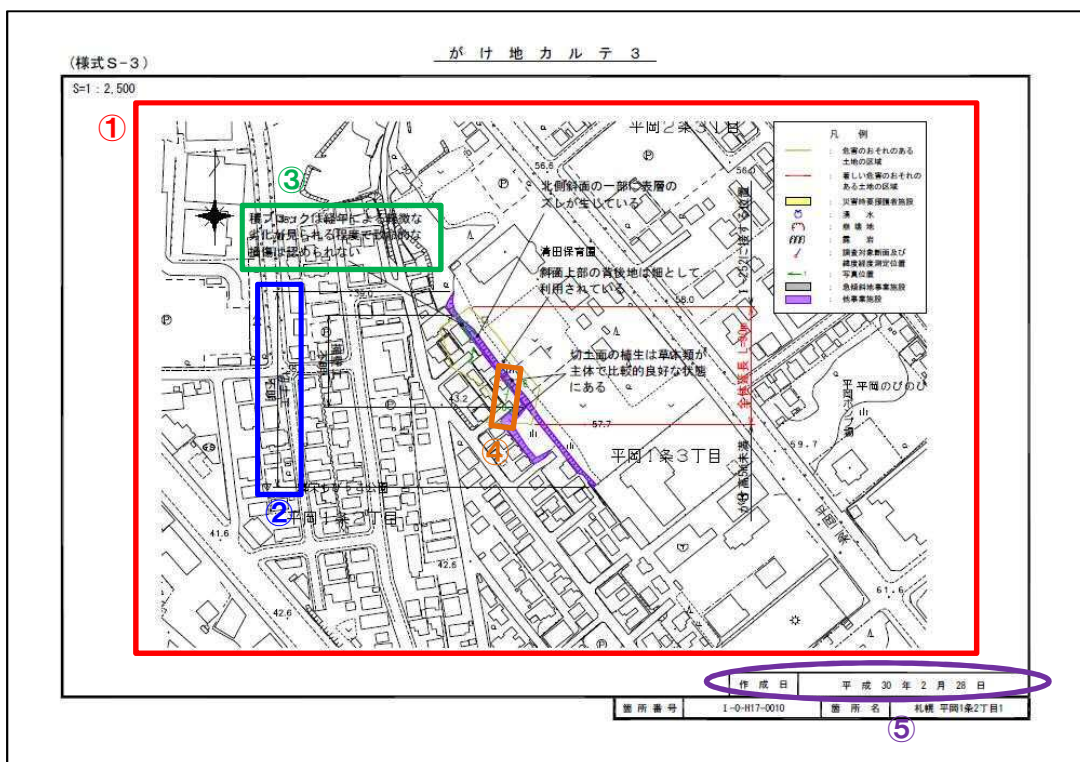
がけ地カルテ3 (様式 S-3) 平面図
